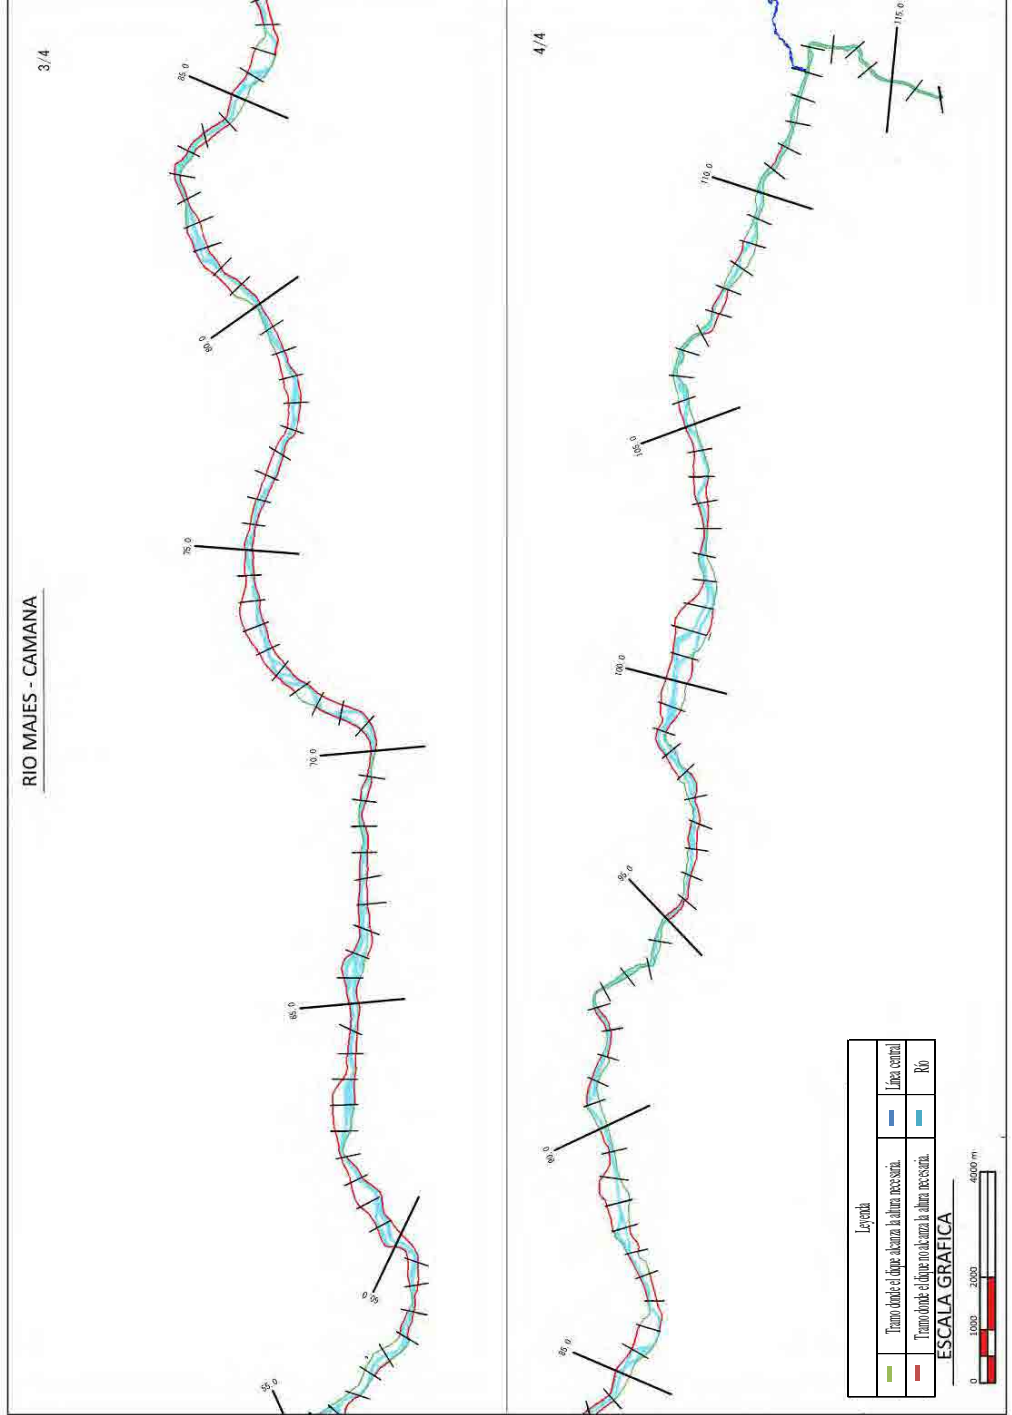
Plano de planta del Río Majes-Camana (55-115K)
